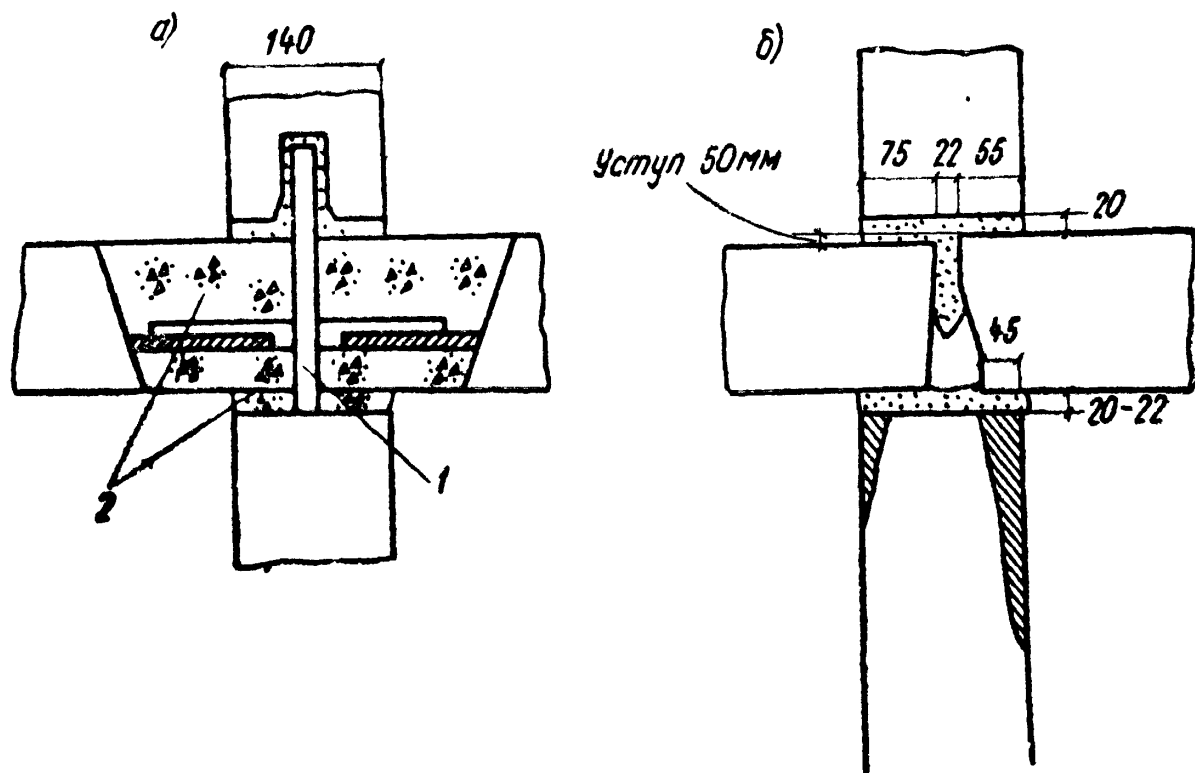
Нарушение прочности бетона в опорах несущих железобетонных перегородок
